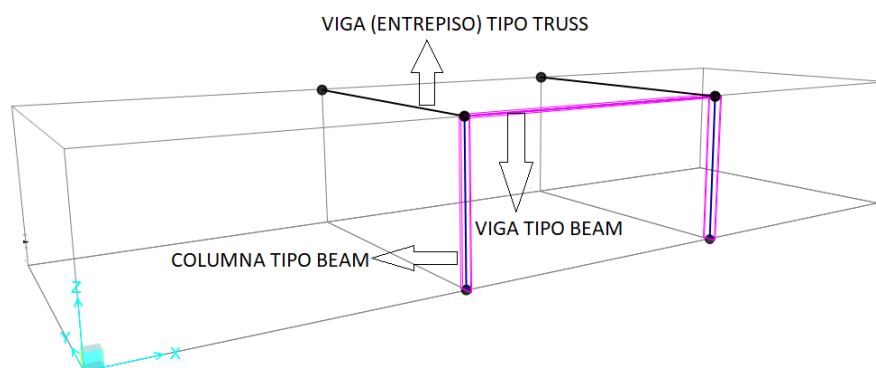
Representación de las columnas y las vigas de los prototipos utilizando elementos tipo BEAM y TRUSS, los cuales están definidos por dos nodos.
